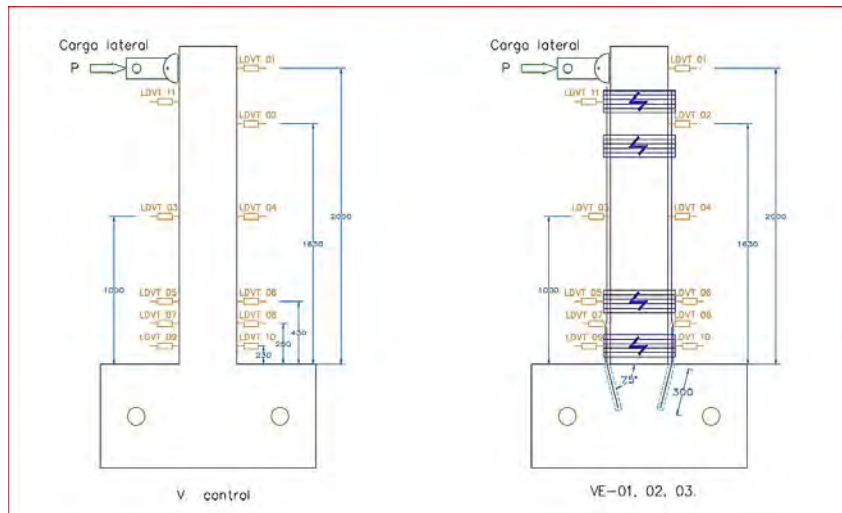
Esquema de las vigas ensayadas en laboratorio de estructuras PUCP.
